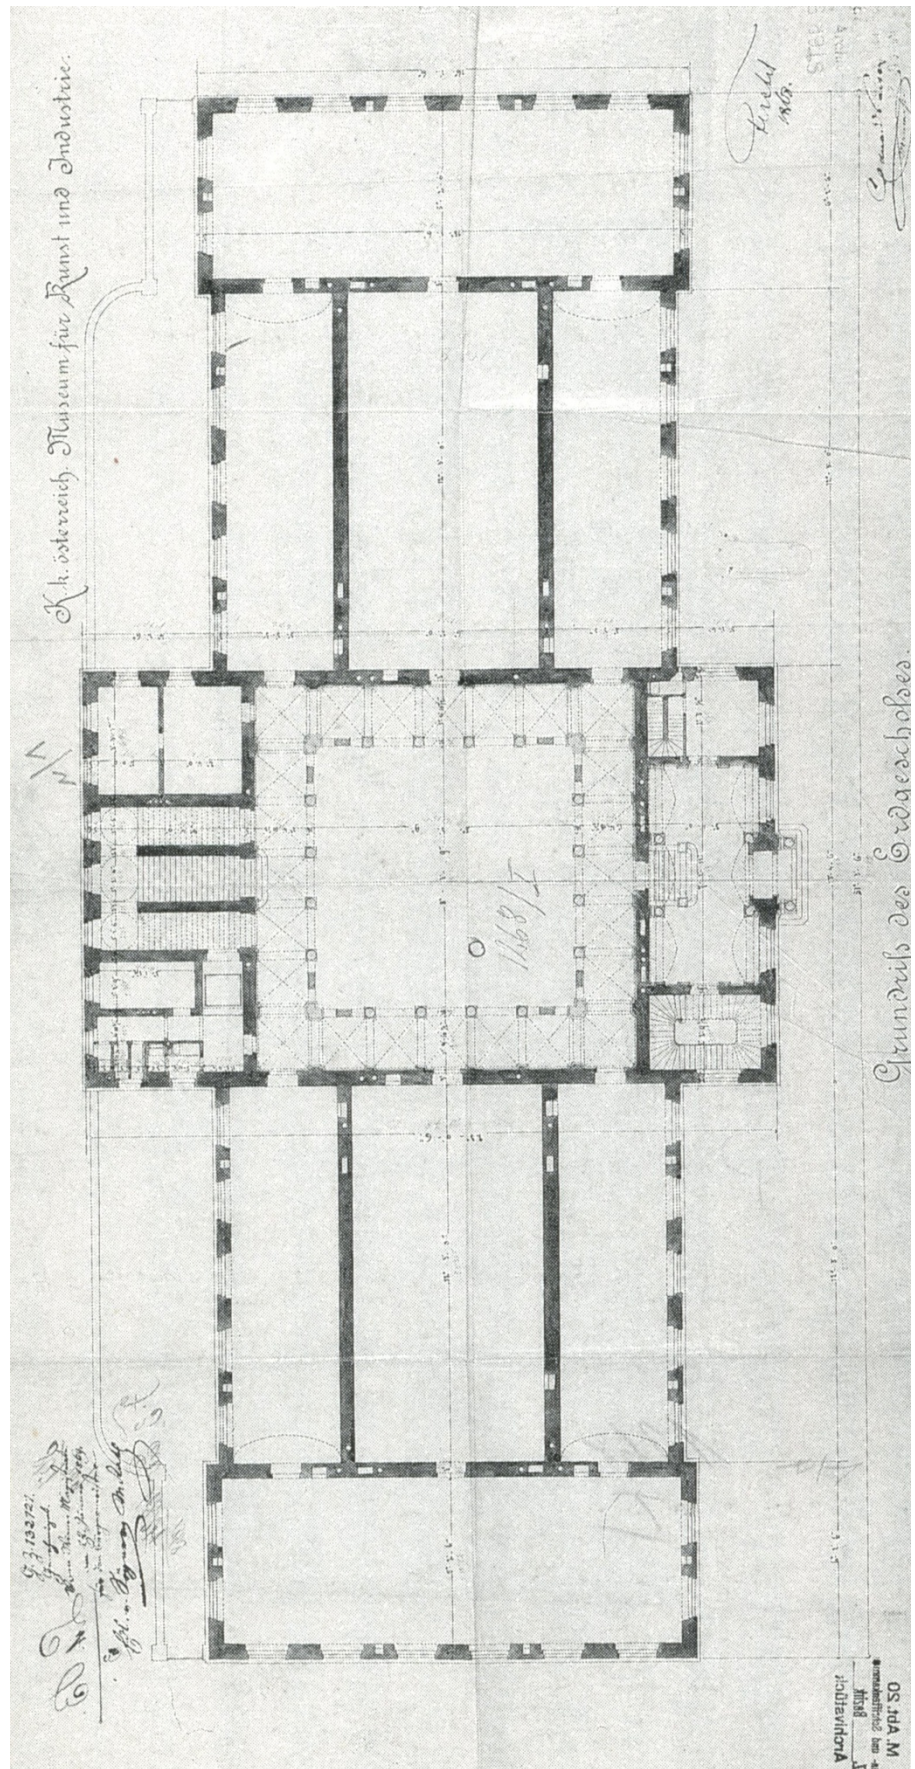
Heinrich von Ferstel, bewilligter Einreichplan, Erdgeschoss 1868
